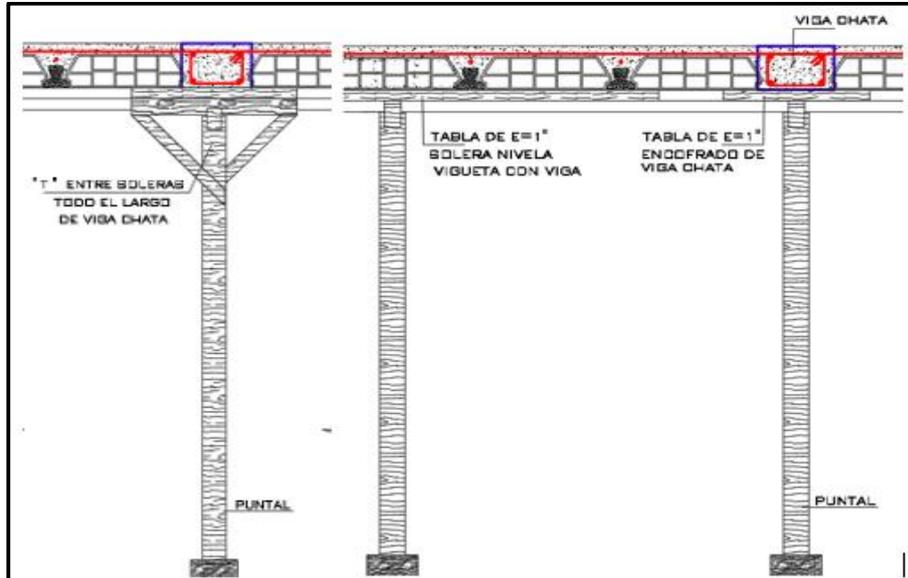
Detalle de apuntamiento de vigas chatas paralelas a las viguetas.
